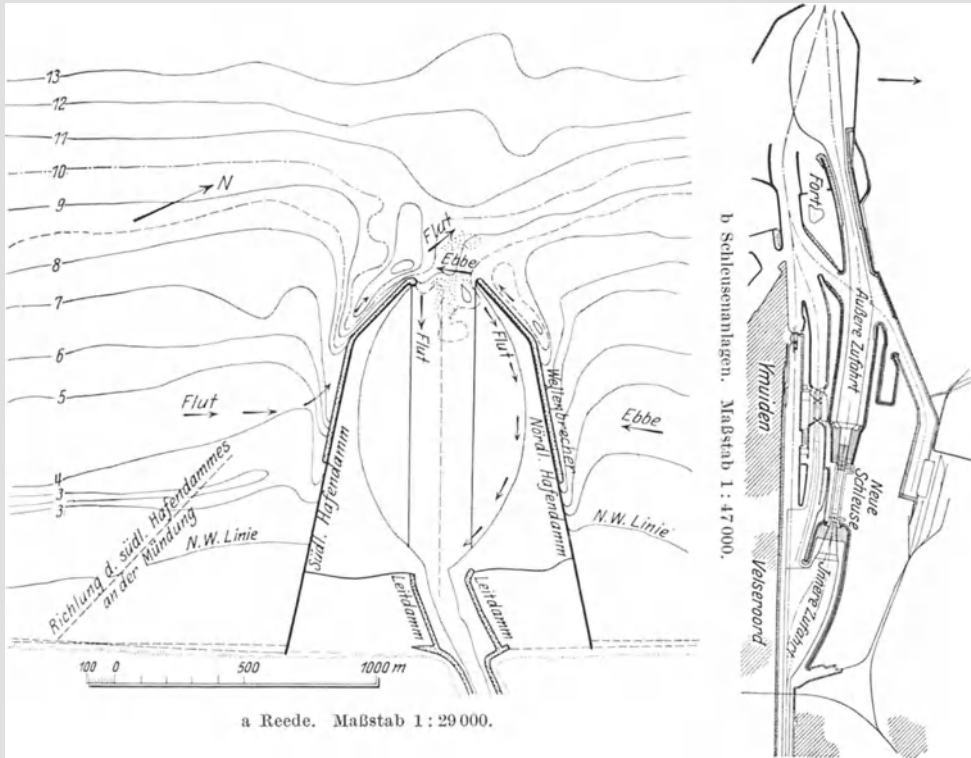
a u. b. Reede und Hafen von Ymuiden. Küstenhafen. Dockhafen. Vorhafen durch Molen geschützt. Hauptwindrichtung: Nordwest bis Südwest. Ausgangspunkt des Seekanals nach Amsterdam.
